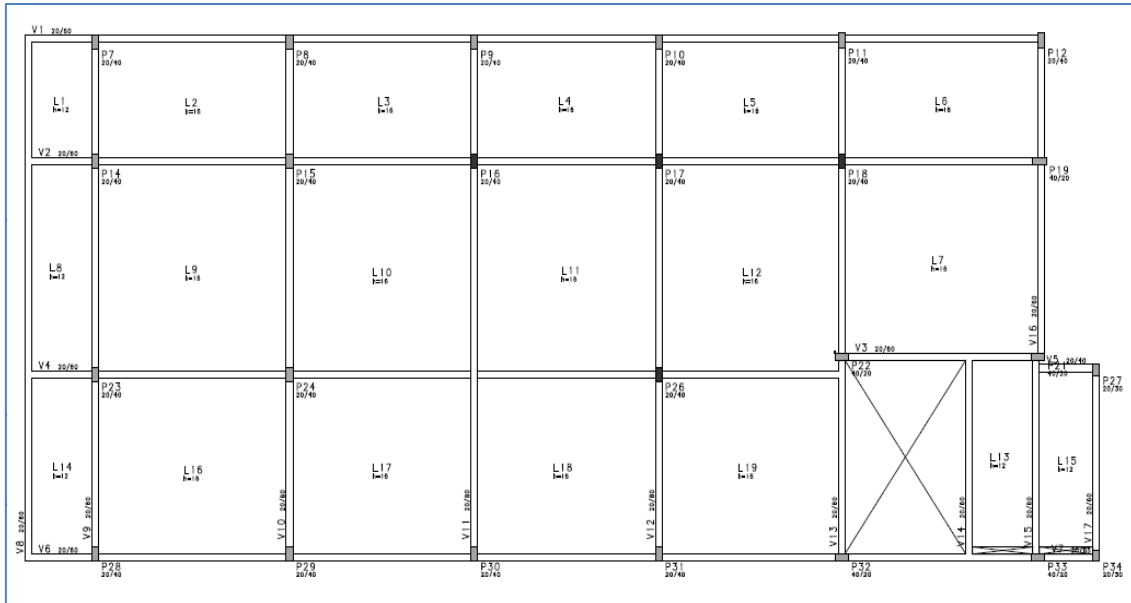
Planta de fôrma: 2º pavimento, concreto armado (CAD/TQS).
